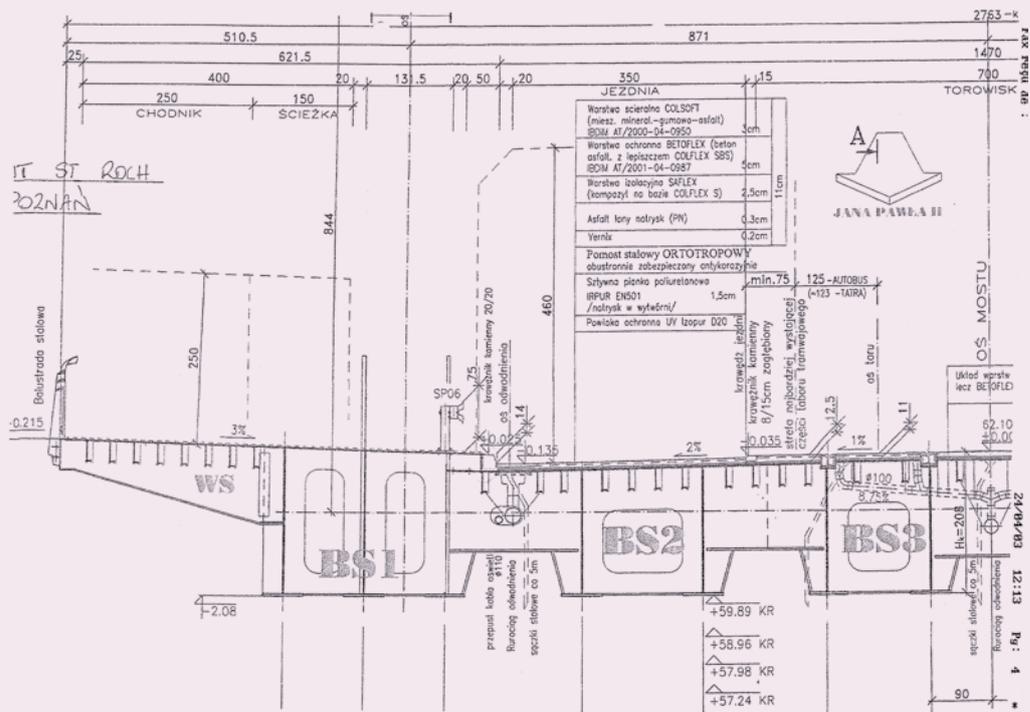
coupe transversale voie normale et trottoir – Source : Colas
